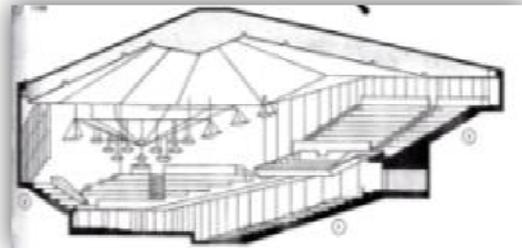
Corte. Sin escala. Fuente: Concert halls and opera houses. Beranek, L.
